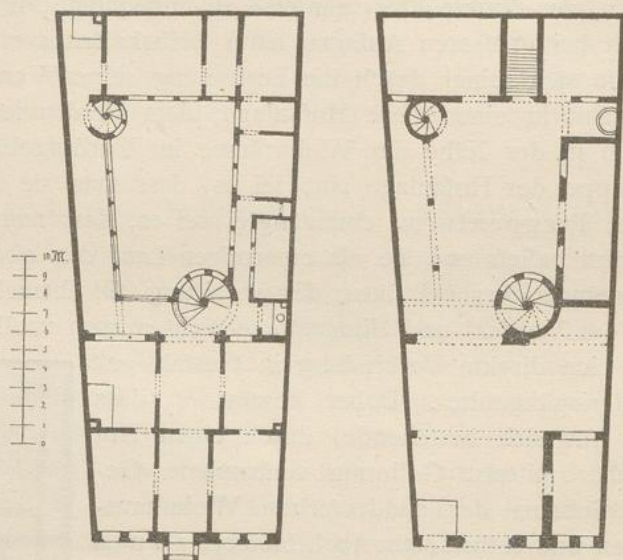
Grundriss des 1. Stocks. Grundriss des Erdgeschosses.
